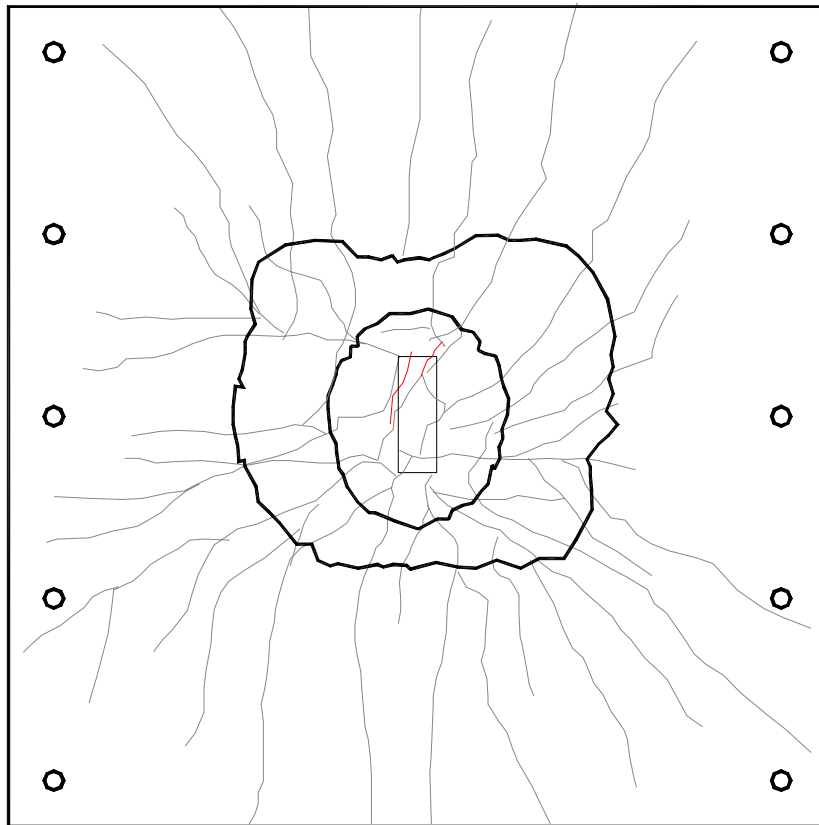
Mapa de fissuração da laje L2B
